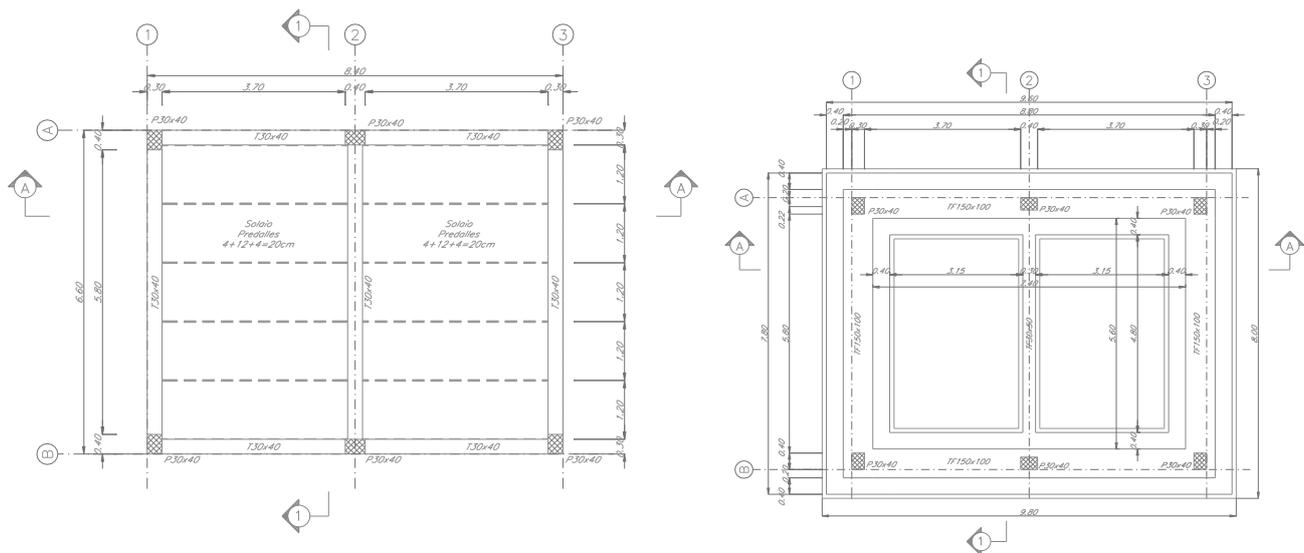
Pianta solaio e pianta fondazioni locale consegne al km 12+883,370
